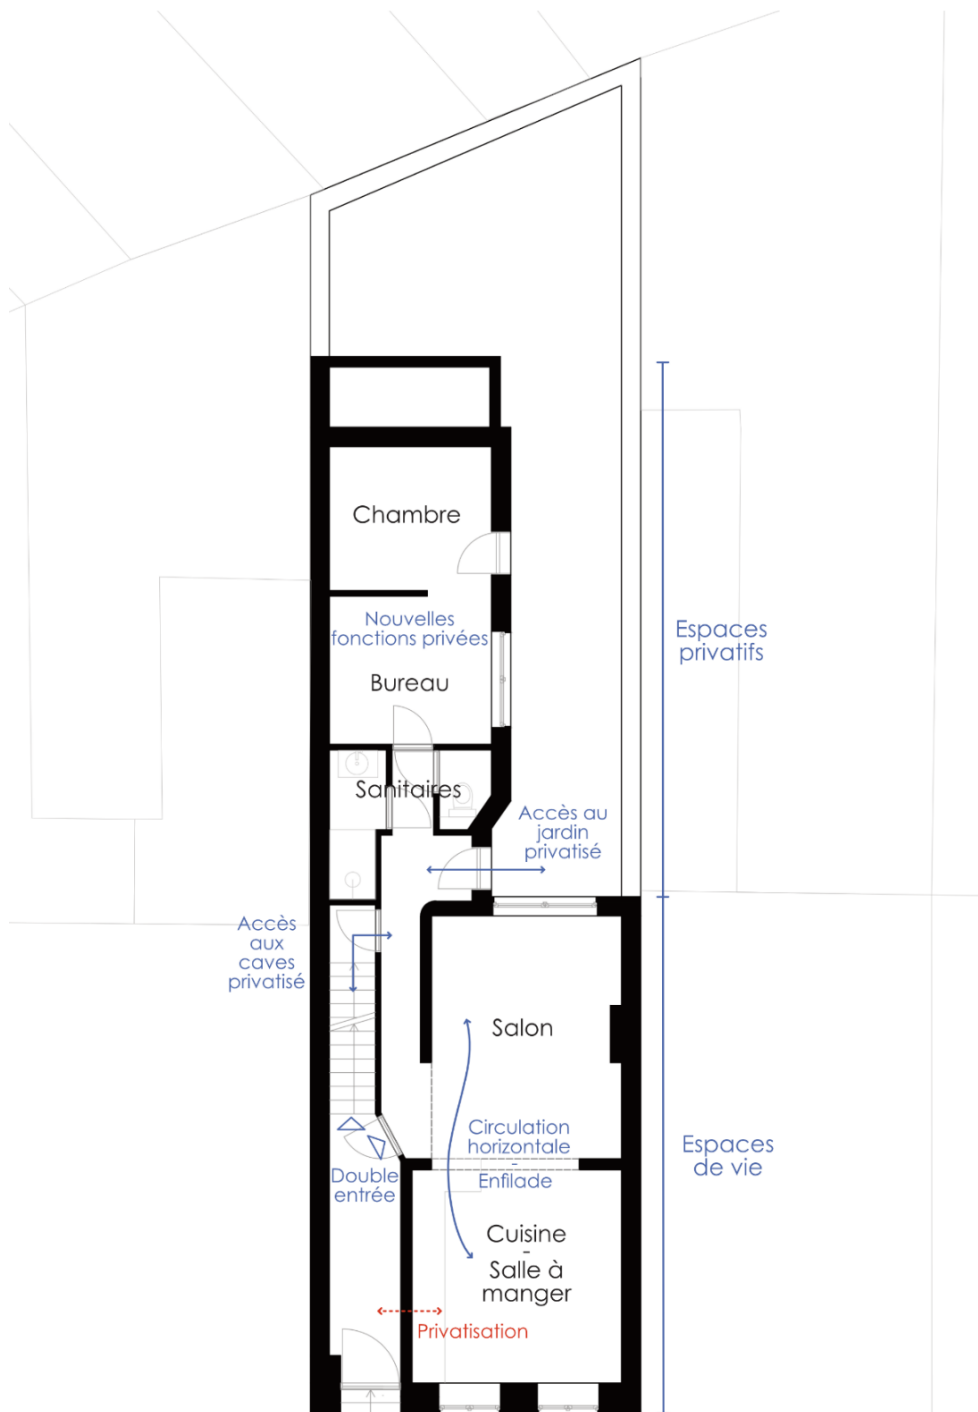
Plan du RDC, appartement de la propriétaire de la maison
